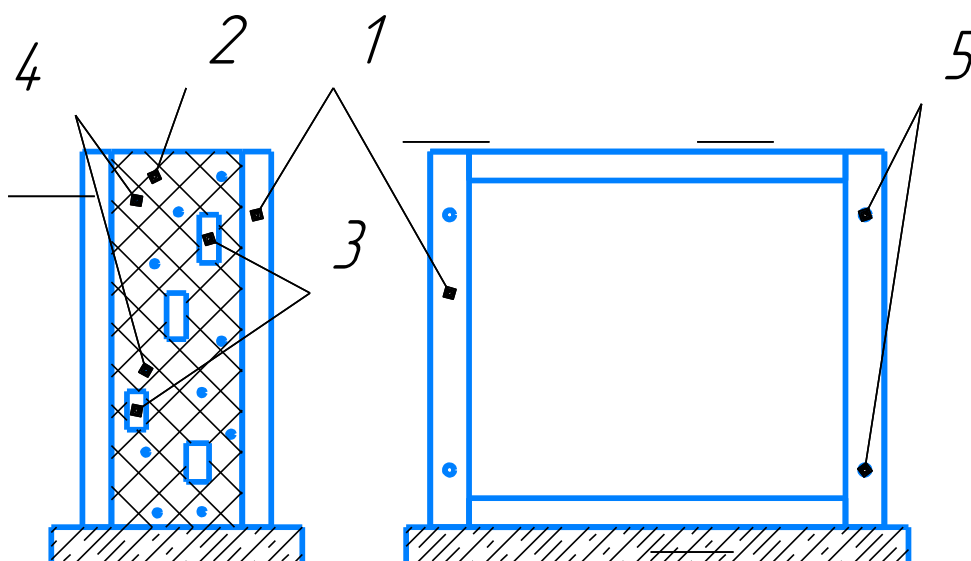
Секция перекусывания арматуры и распила деревянных элементов:
